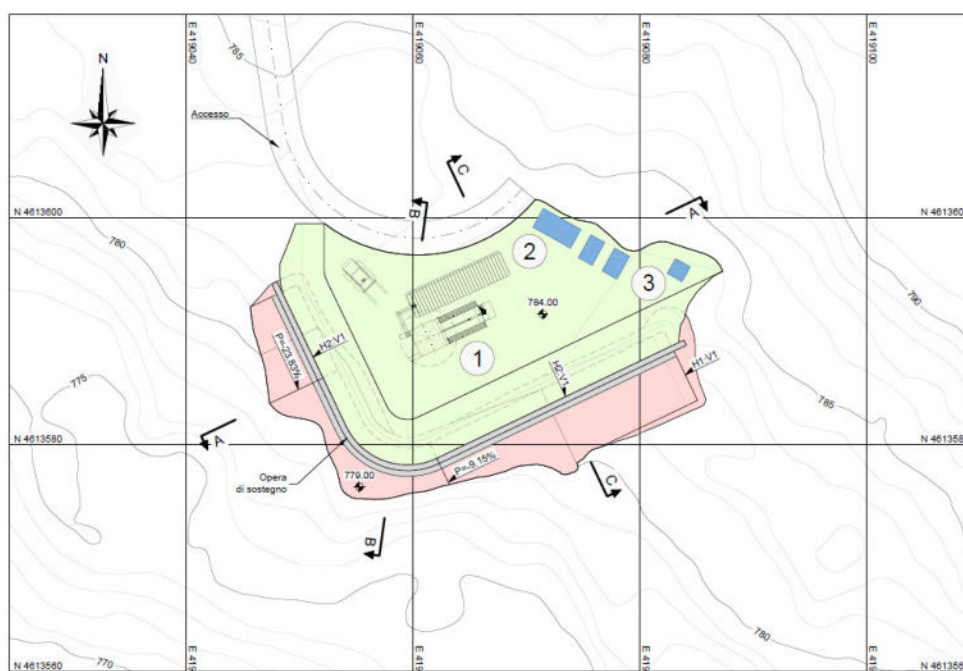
Ambito Pizzone - Area di cantiere CA.PV – Pozzo estrazione fumi della centrale
